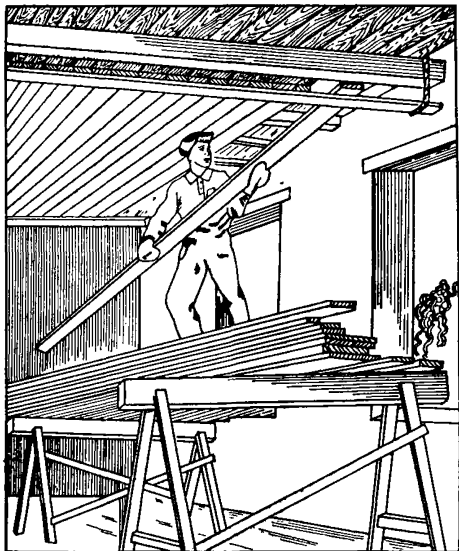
Подшивка потолков досками с помощью приспособления Сычева
